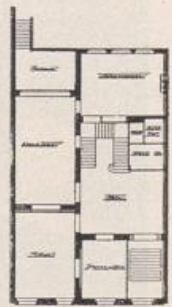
Tonhallenstrasse 11. Erdgeschoss.
